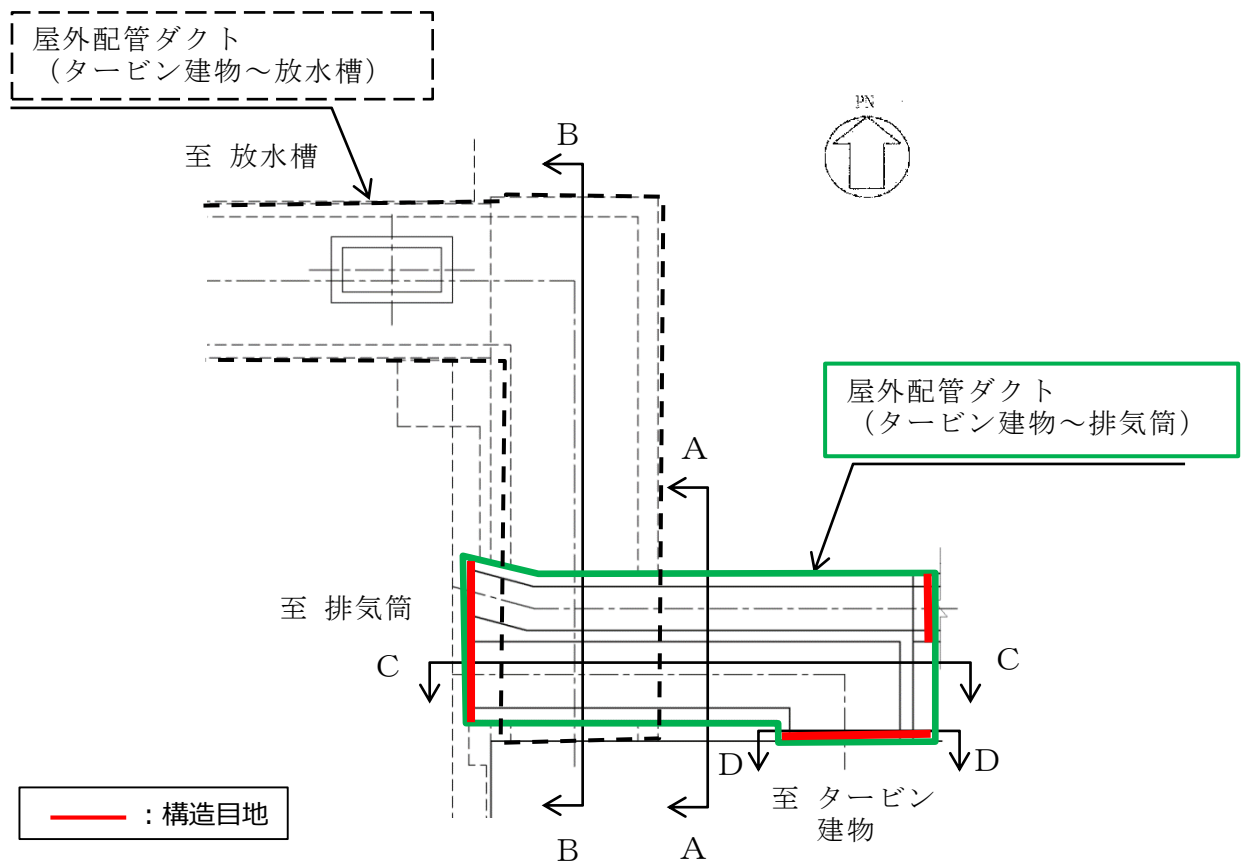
屋外配管ダクト（タービン建物～排気筒） 平面図
